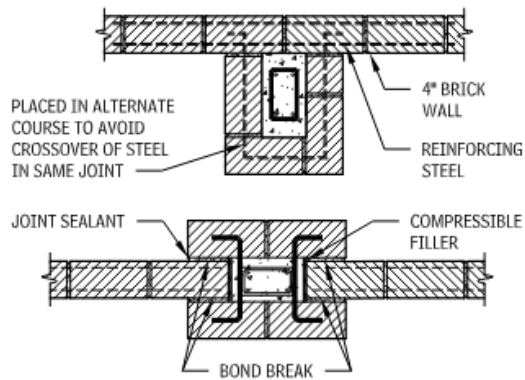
unit pilaster khusus yang umum digunakan dengan sambungan control
